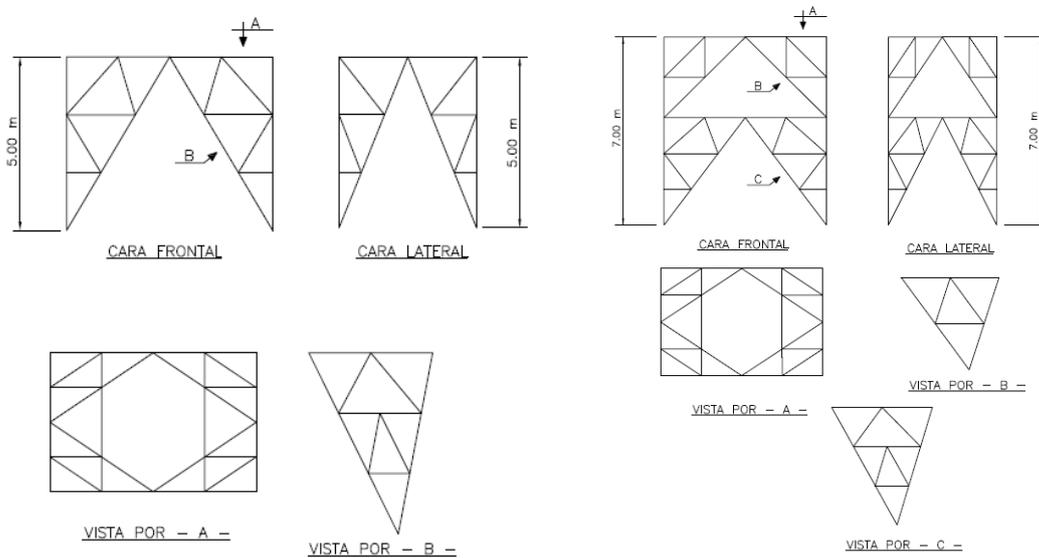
Detalles constructivos del recrecido de los apoyos (recrecido de 5 y 7 m). Fuente: Red Eléctrica
